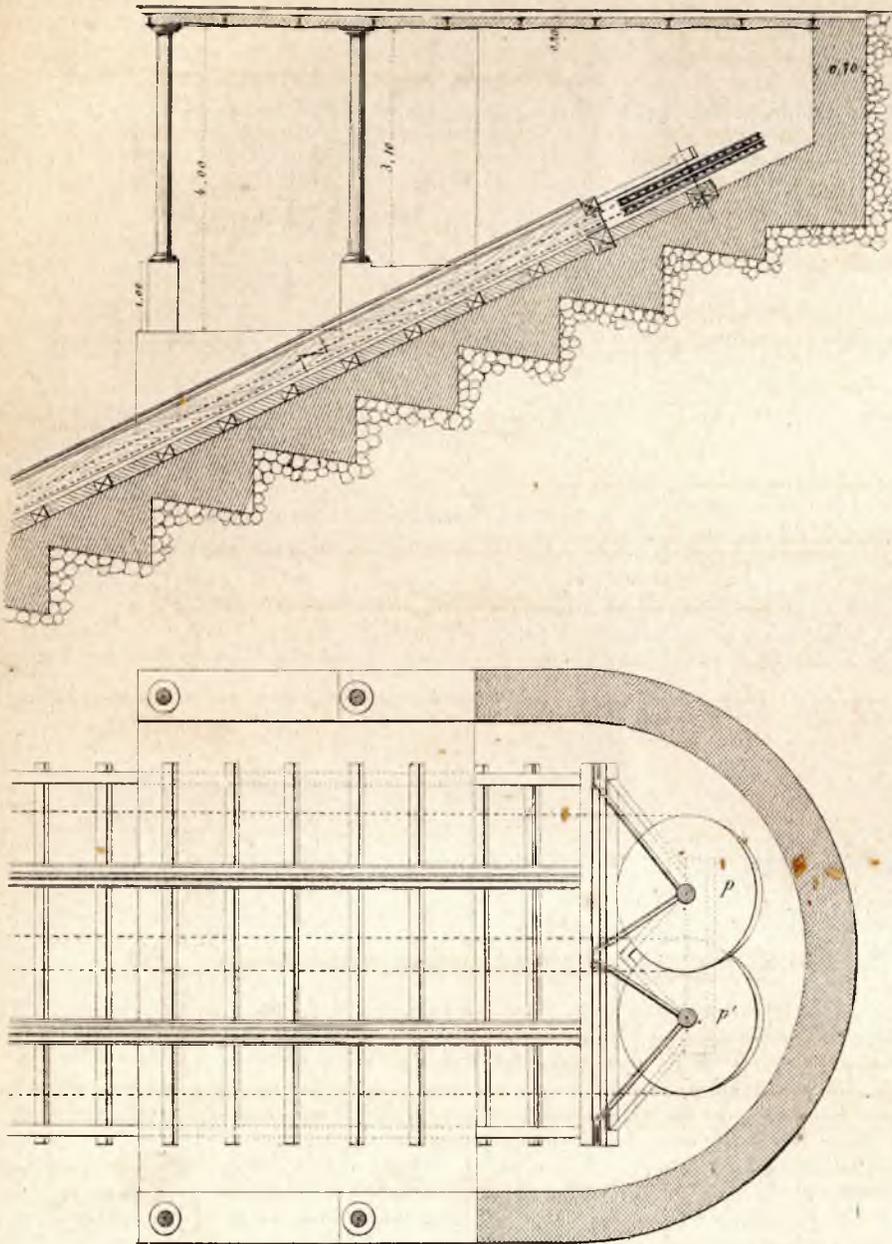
Stazione superiore. Elevazione e Pianta. Scala di 1 : 103.
